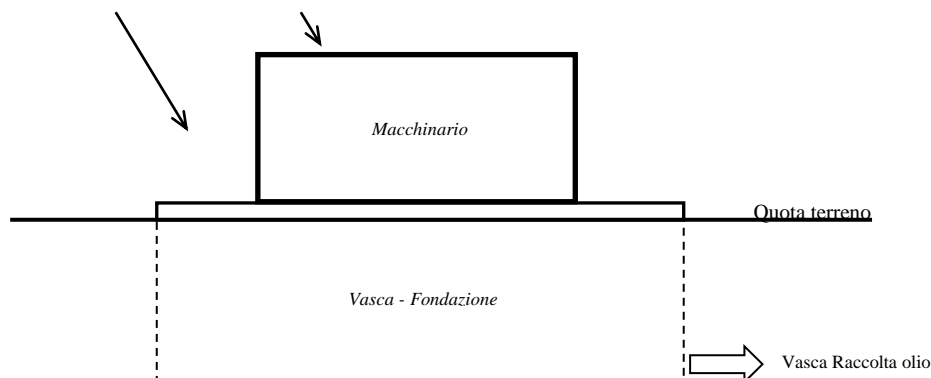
Rappresentazione schematica del sistema Vasca-Fondazione
